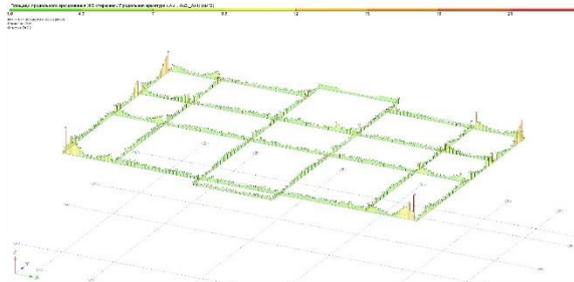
Расположение ригелей и максимальная площадь армирование на нижней грани ригелей с первого по пятые этажи пяти этажного каркасного железобетонного здания без внутренних и наружных стен.
